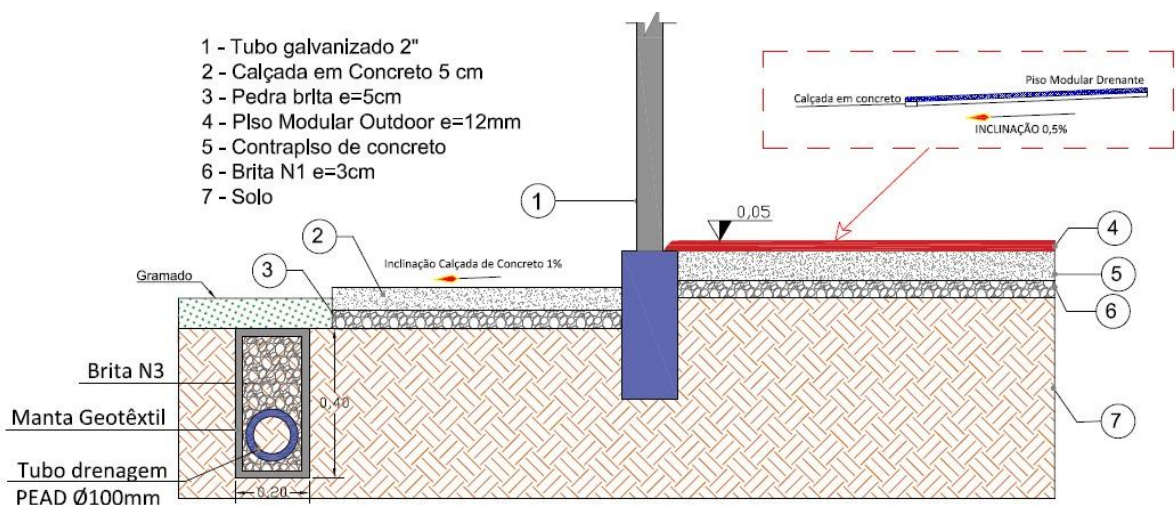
Detalhe de instalação Drenagem (Fonte: Autor/2024)
